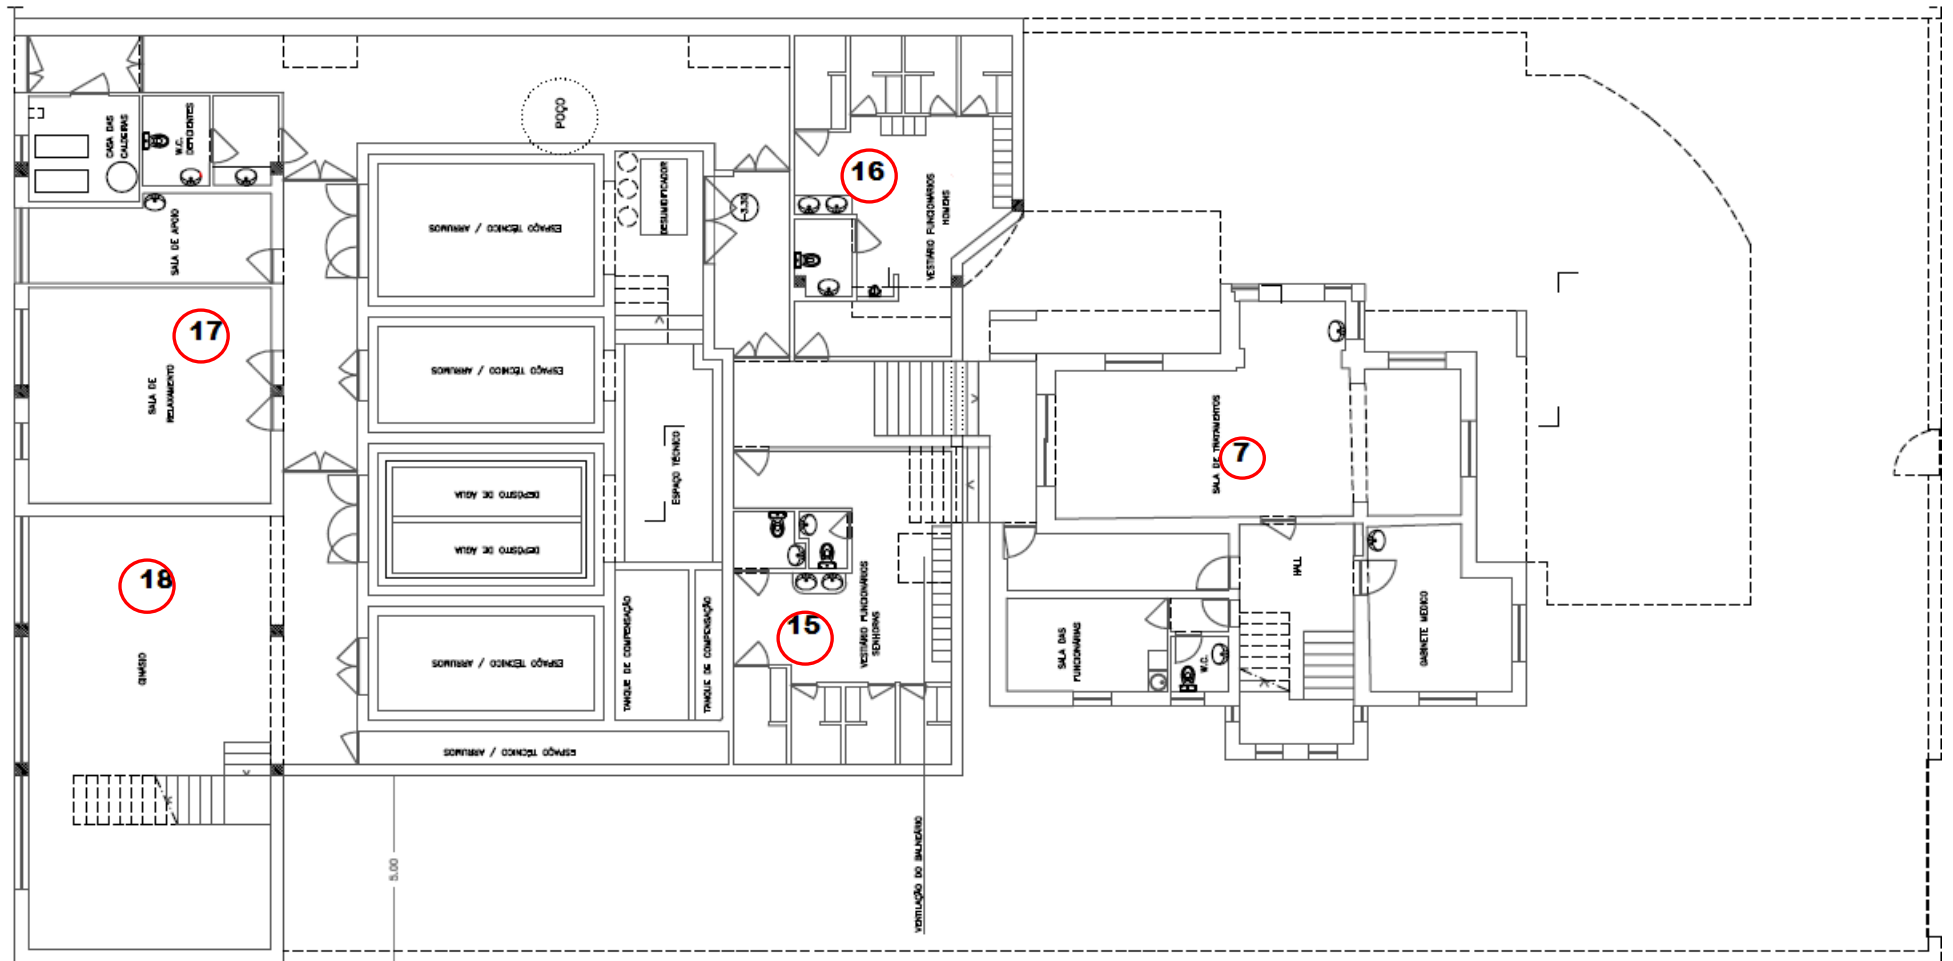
1 – Planta esquemática do Piso 0 com marcação dos pontos de análise da QAI - CAVE
